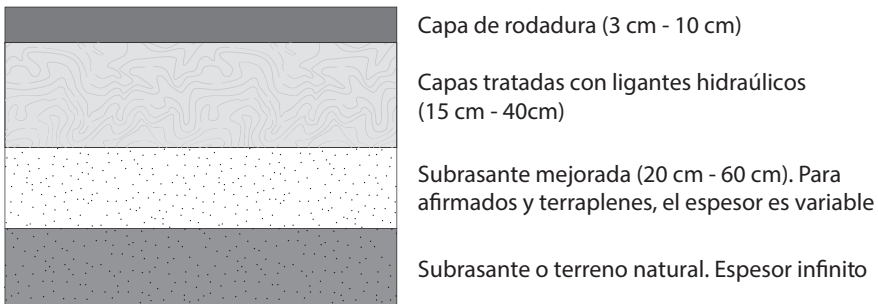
Figura B. Perfil típico de una estructura de pavimento con capa asfáltica gruesa
